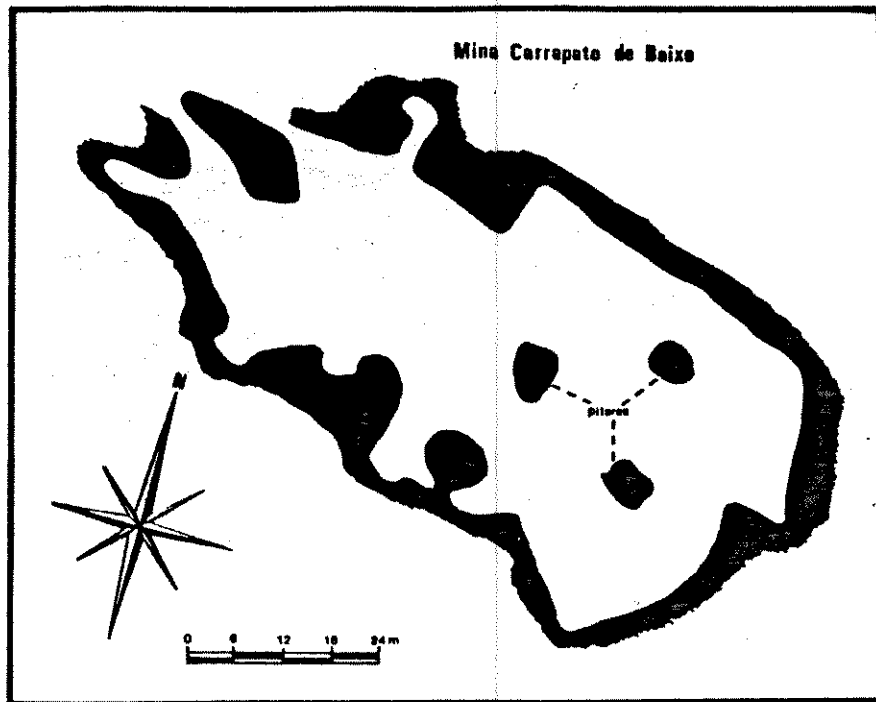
Traço em planta da Mina Carrapato de Baixo (extraído de Moraes & Barbosa, 1939).
